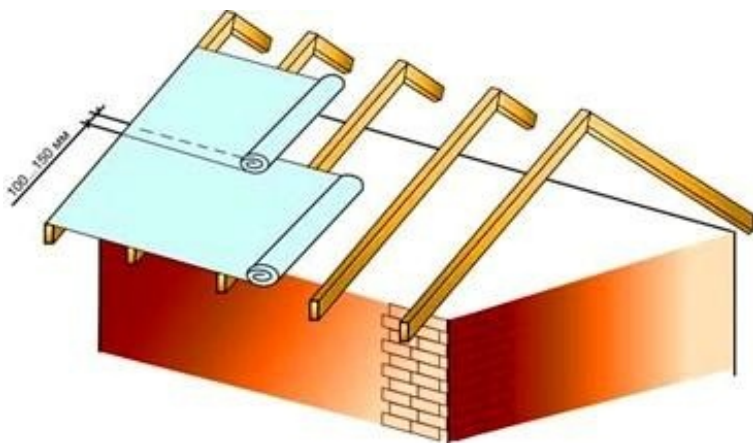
Укладка гидроизоляционной паропроницаемой пленки на стропила
